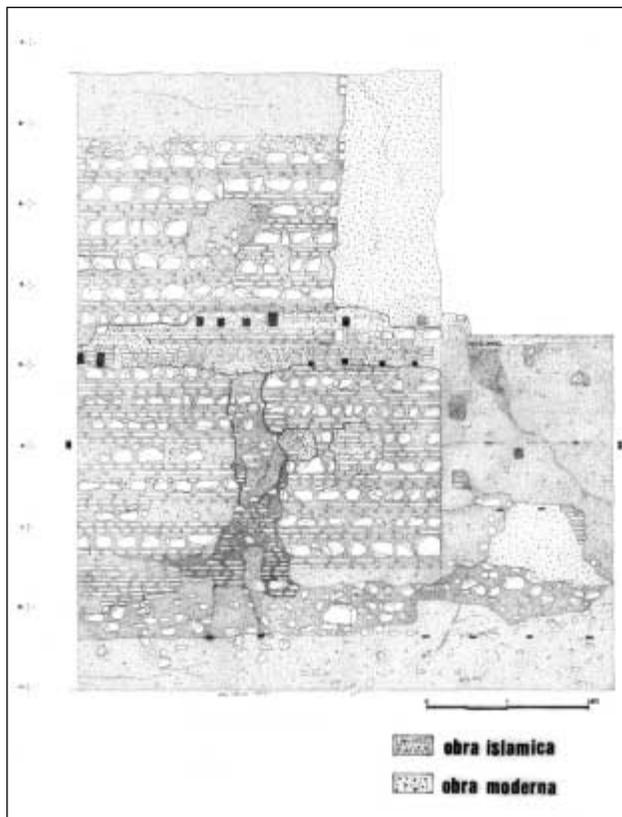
Alzado de la muralla con la reparación de ladrillo y mampostería de época cristiana.
